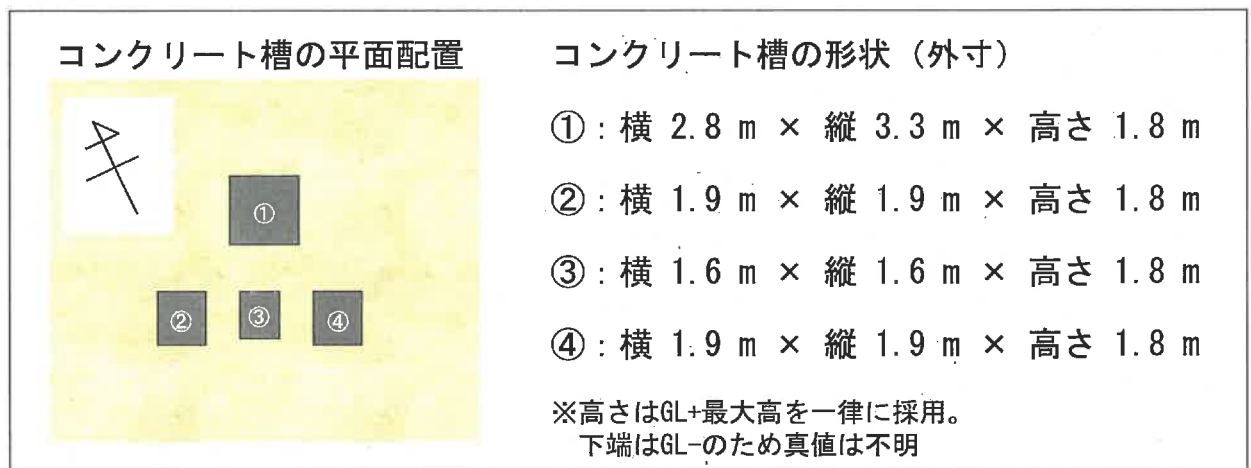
コンクリート槽の配置概略図（図 3-2 を再掲）
